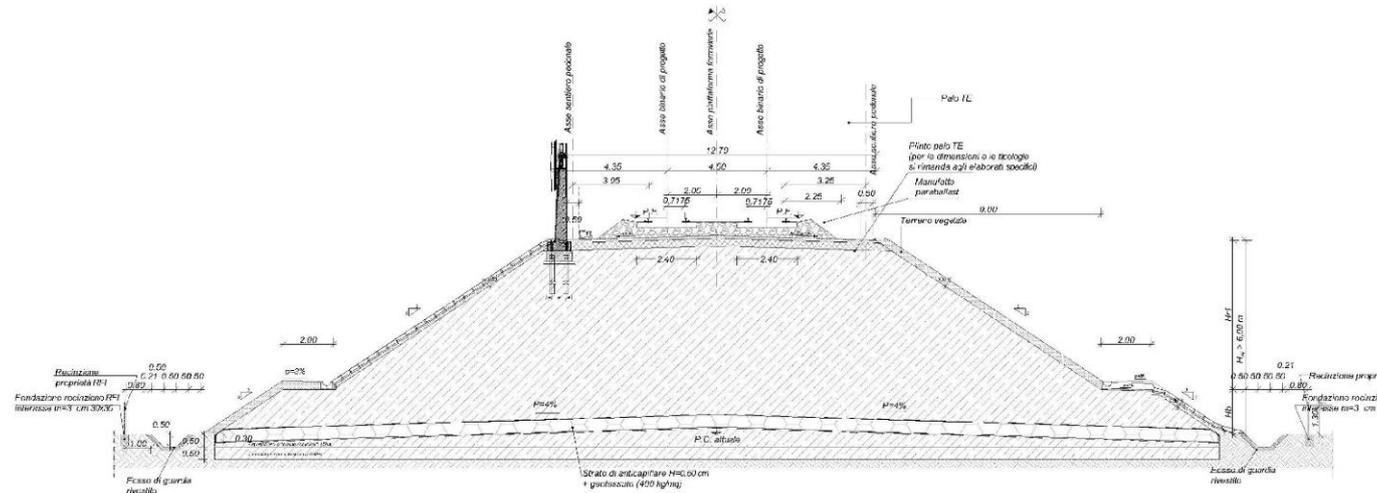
Sezione tipo ferroviaria in rilevato a doppio binario con BA tipo “HS”
